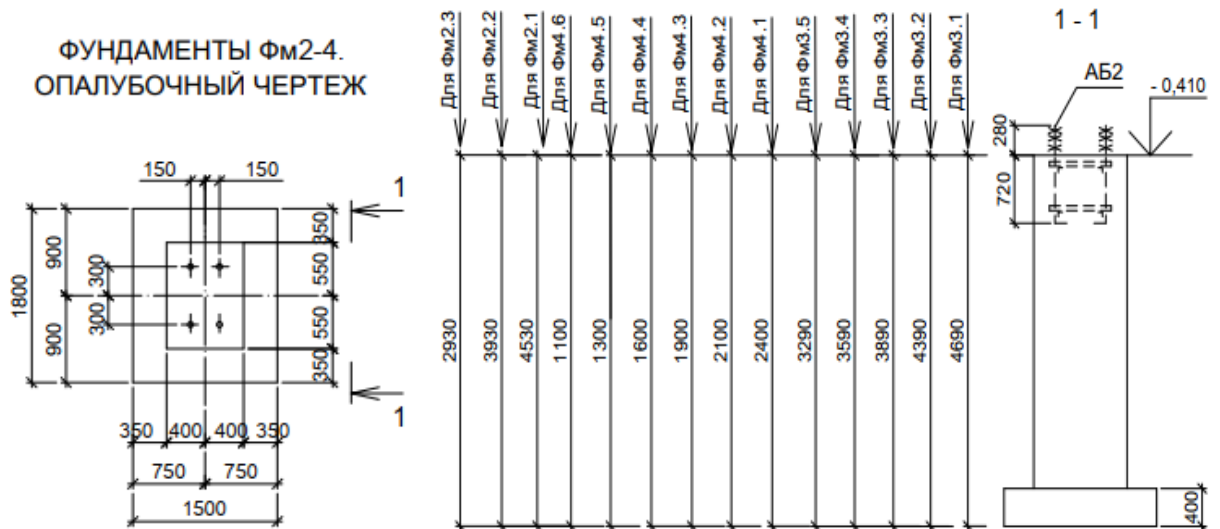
Схема фундаментов ФМ2-ФМ4
